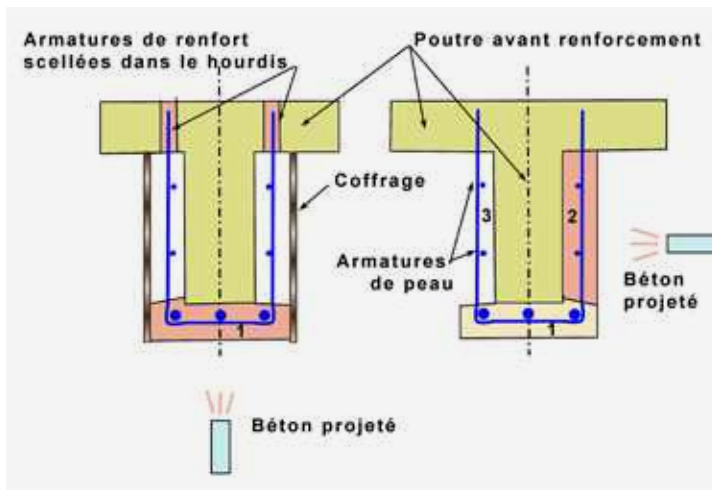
principe de renforcement d'une poutre par ajout de béton et d'armatures
